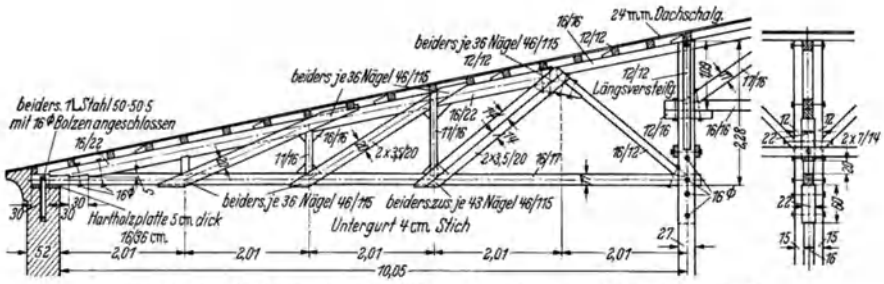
Messehalle 4 in Leipzig. Binderkonstruktion des linken Seitenschiffs.
